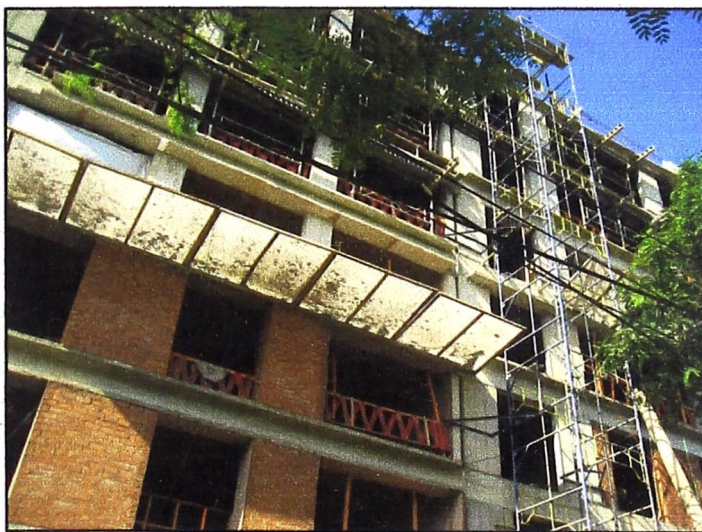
Elevador de carga instalado en el frontis de una obra.
